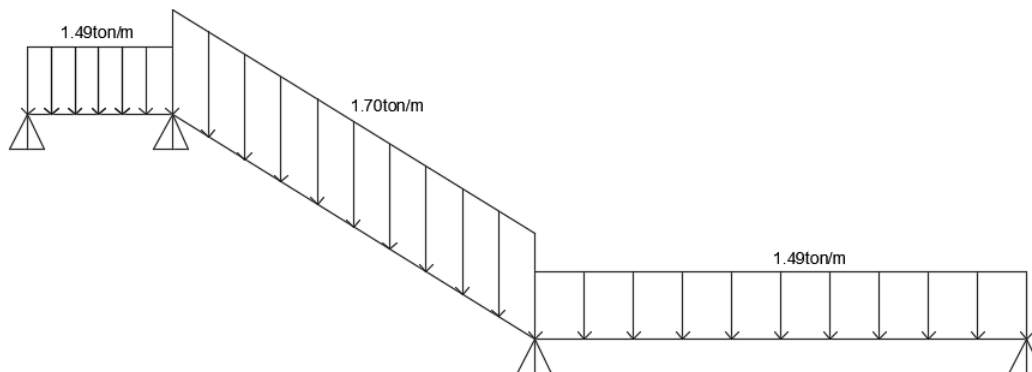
Modelo estructural con cargas aplicadas (Ton/m)
